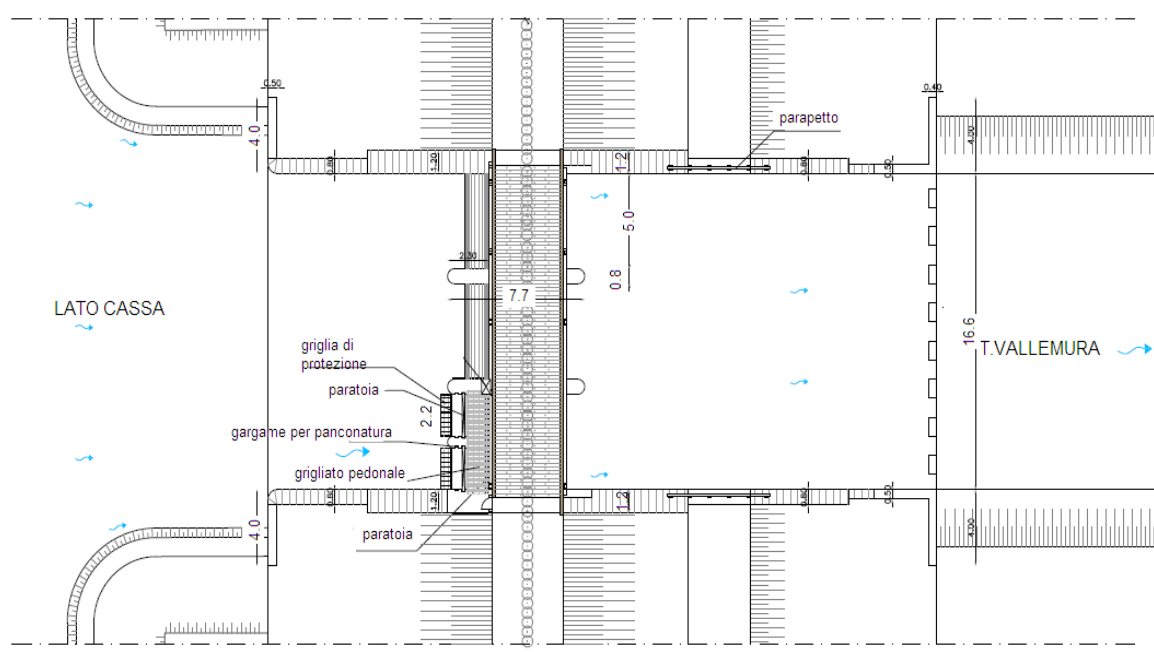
Planimetria della traversa di regolazione. Cassa sul T. Vallemura.
